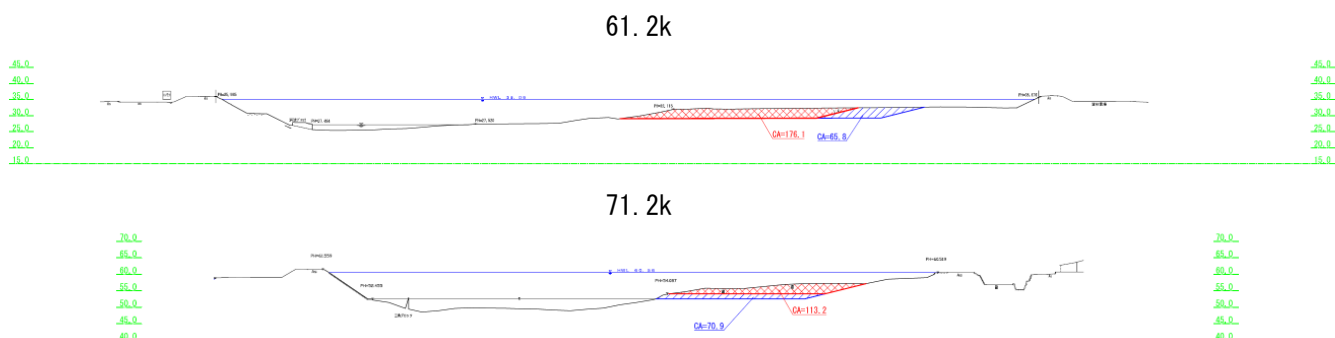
河道改修+遊水地+水田貯留案 横断面図 (※赤・青色範囲が整備イメージ)
